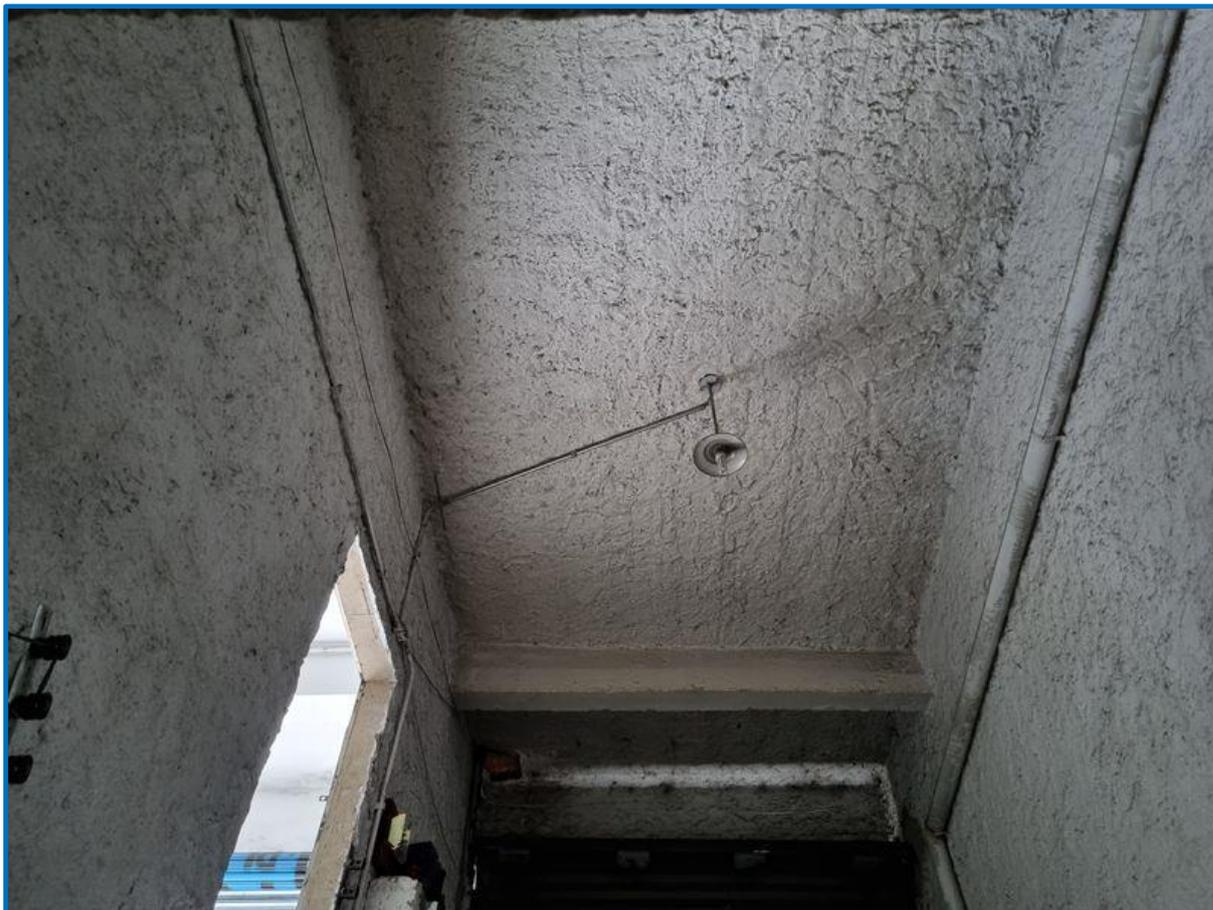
Vista do revestimento da face externa da copa da “Benfeitoria 01 – Edificação Principal (Trecho Comercial)”, a partir da rampa de acesso ao subsolo.
